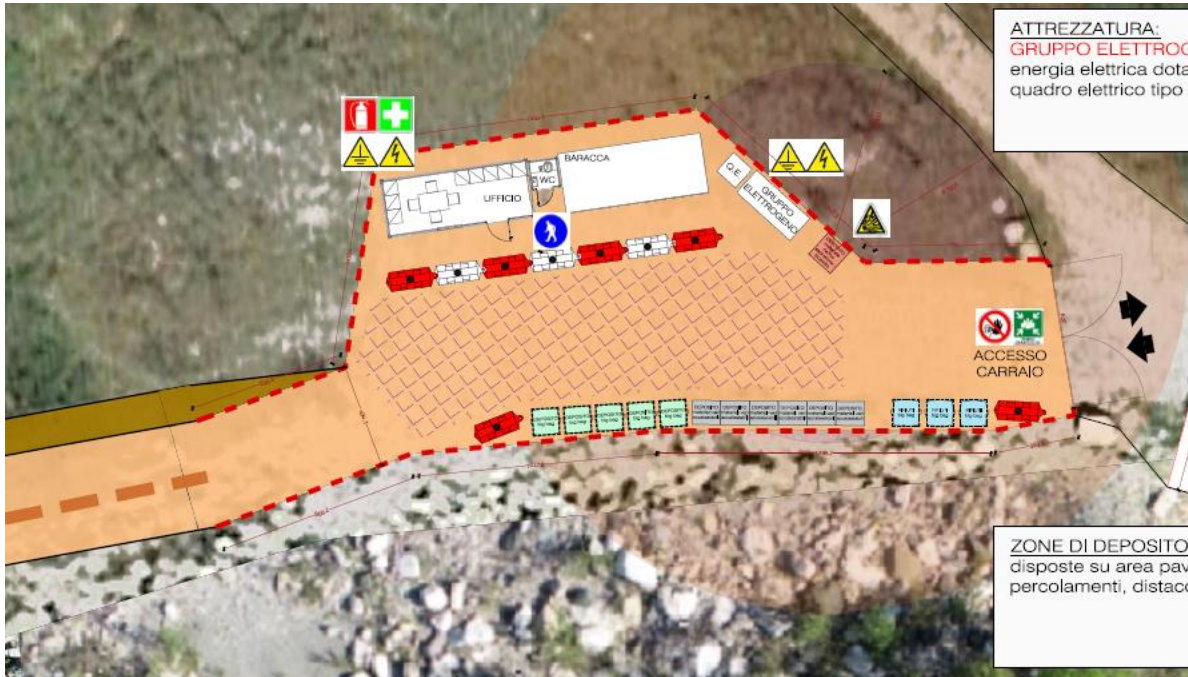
Estratto dell'allegato 7.6.1 Accantieramento e prima fase d'intervento che individua la collocazione del cantiere base
